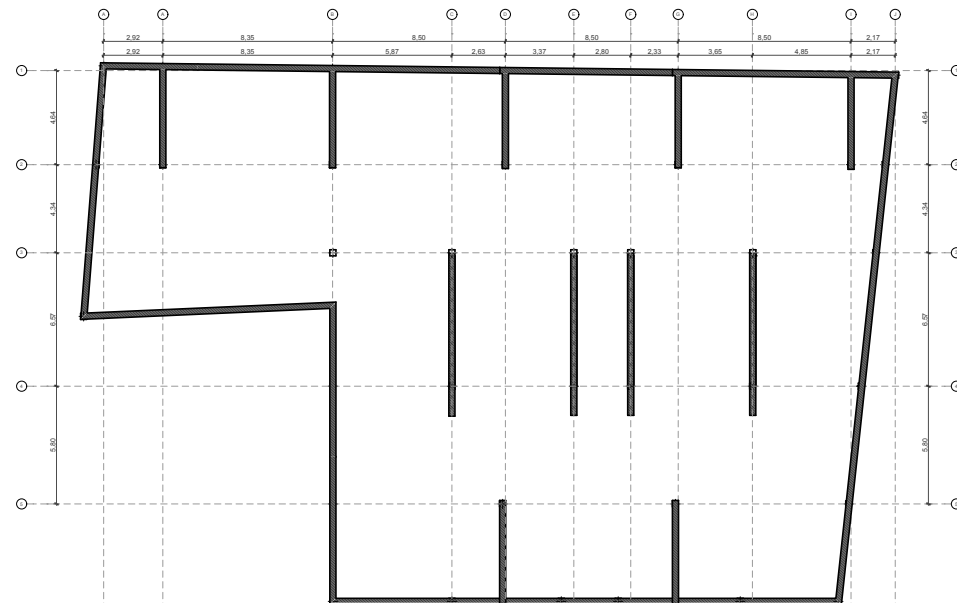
Esquema estructural Propuesta Conjunto Habitacional
